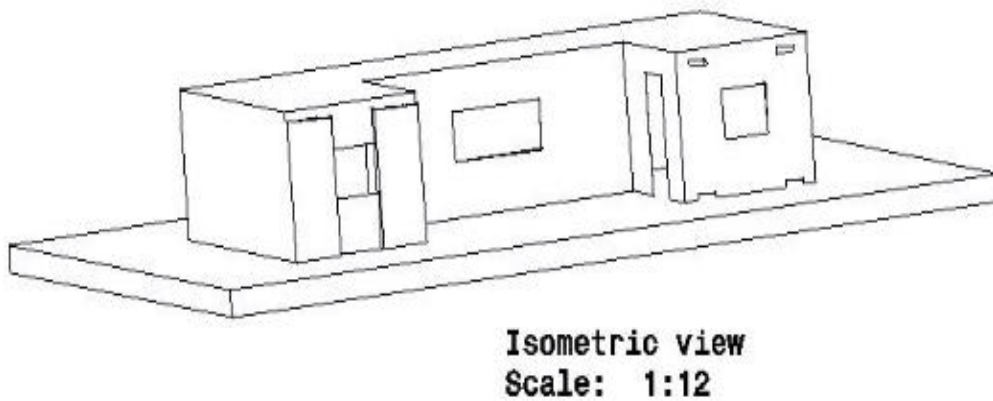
Módulo de alojamiento con dos muros solares instalados en la fachada sur en la parte derecha.
